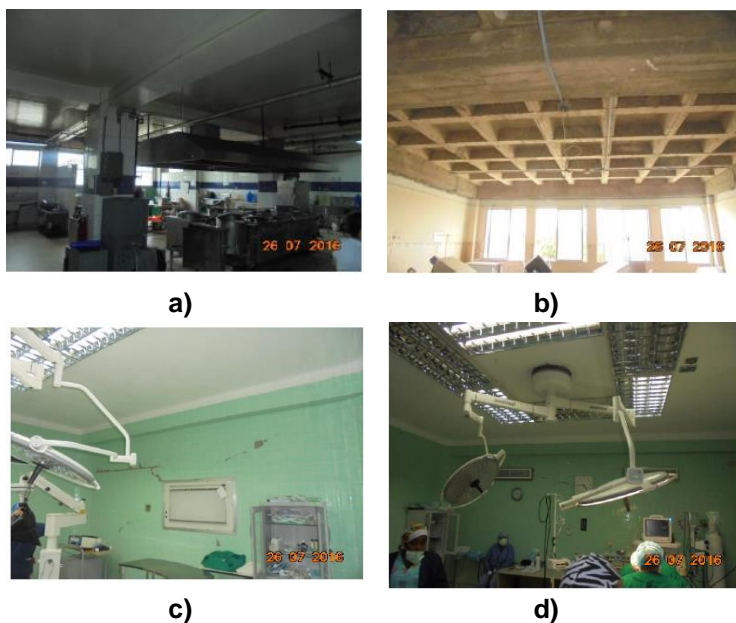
Bloque Estructural 3 de Hospital Rodríguez Zambrano; a) Columnas y vigas descolgadas sin daño; b) Losa nervada en dos direcciones y vigas descolgadas sin daño; c) Rajaduras en Paredes; d) Rajadura en paredes del área de quirófanos. Fuente: Aguiar *et al.* (2016,1).
